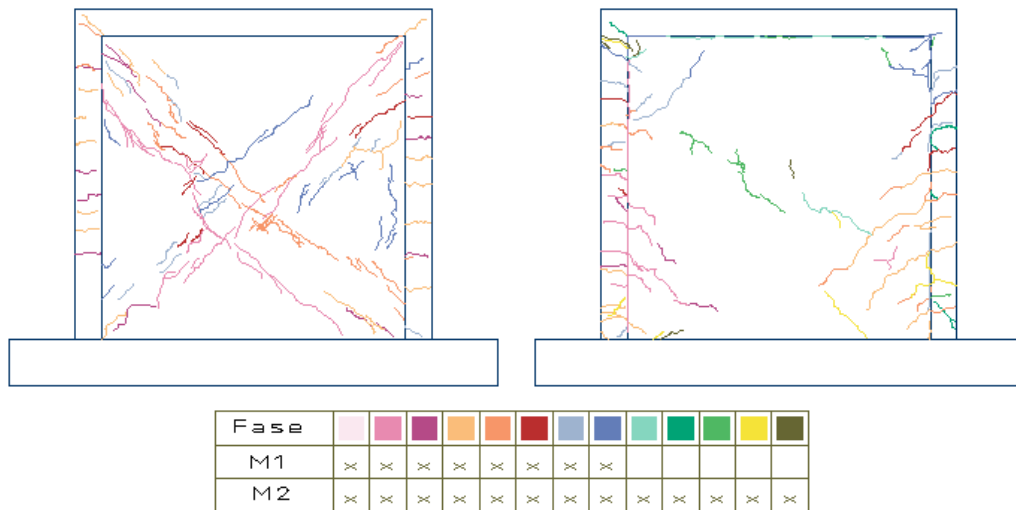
Secuencia de grietas, muros M1 y M2
